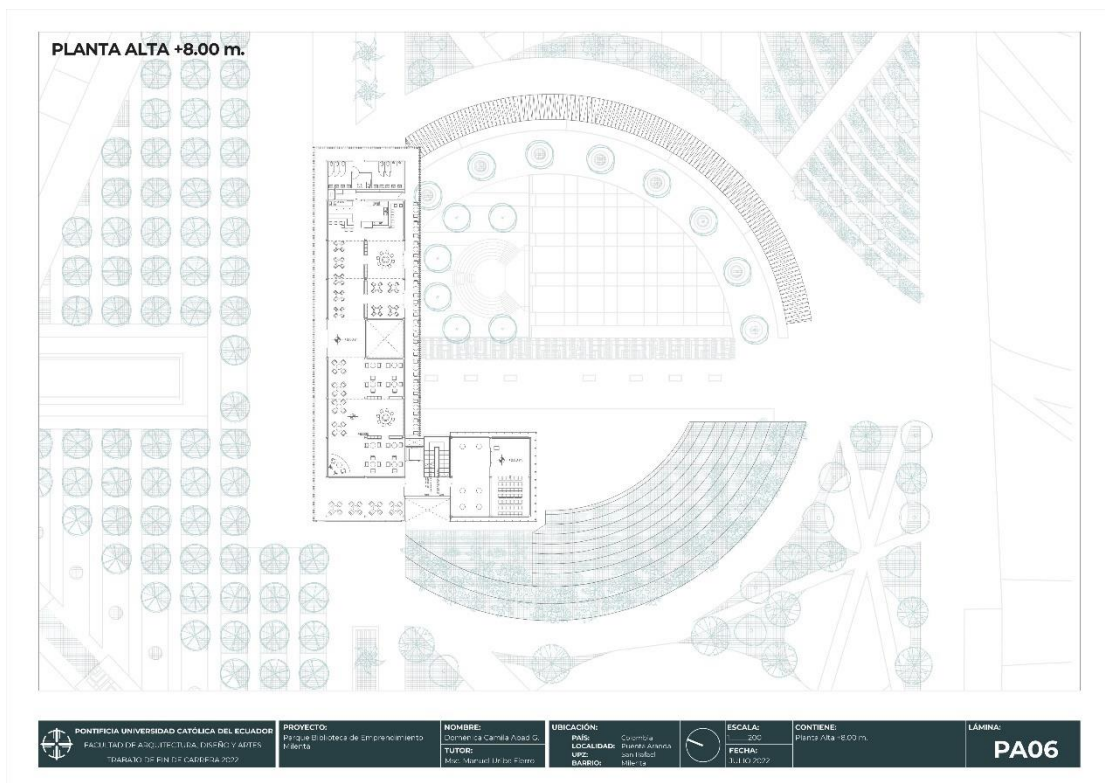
Planta Alta +8.00m (Abad,D. 2022)
